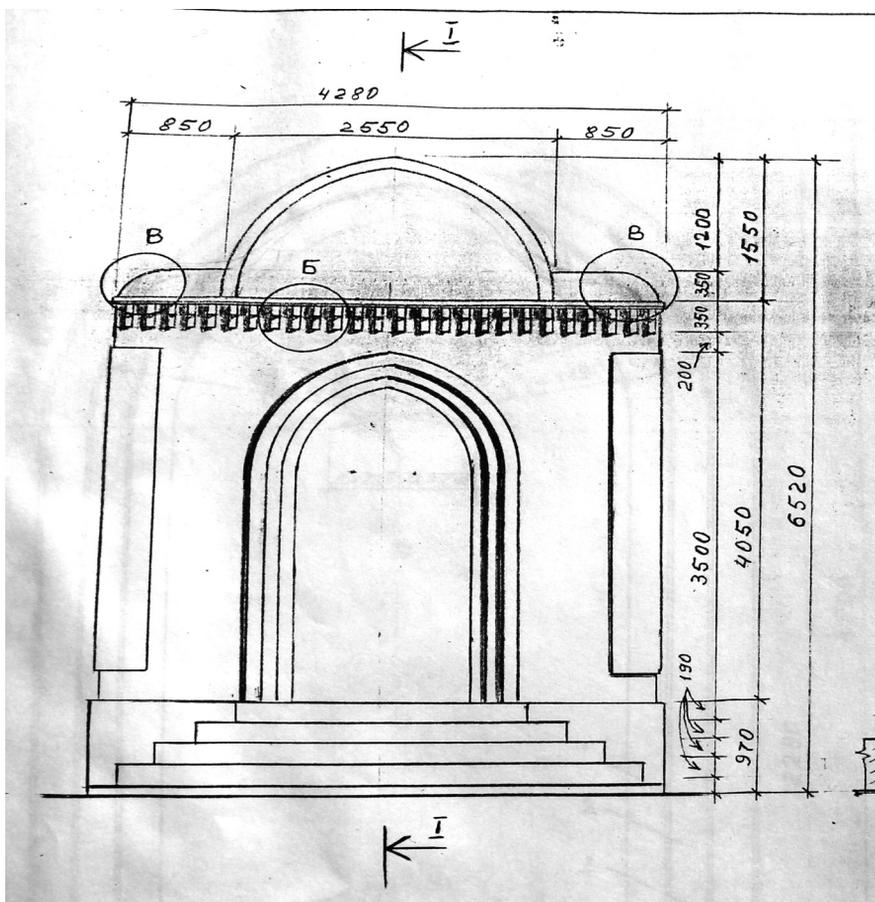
Фрагмент рабочего проекта реконструкции здания мечети
